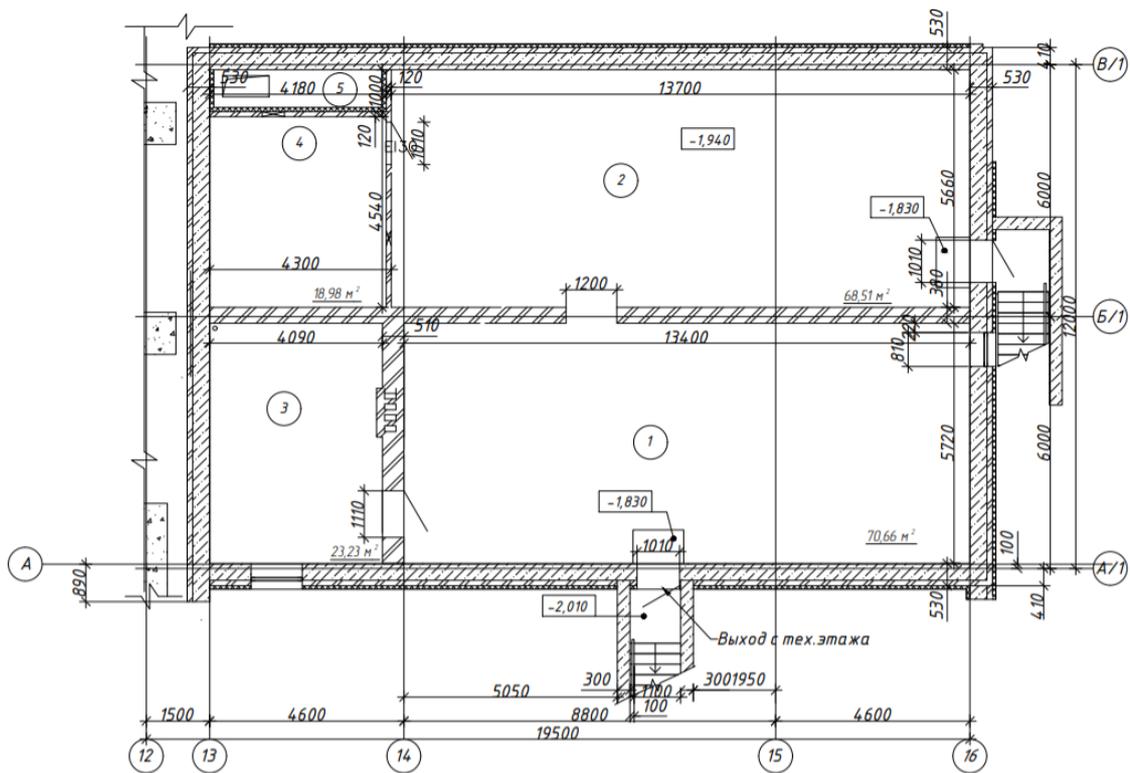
Фрагмент плана АБК на отметке минус 1.940
